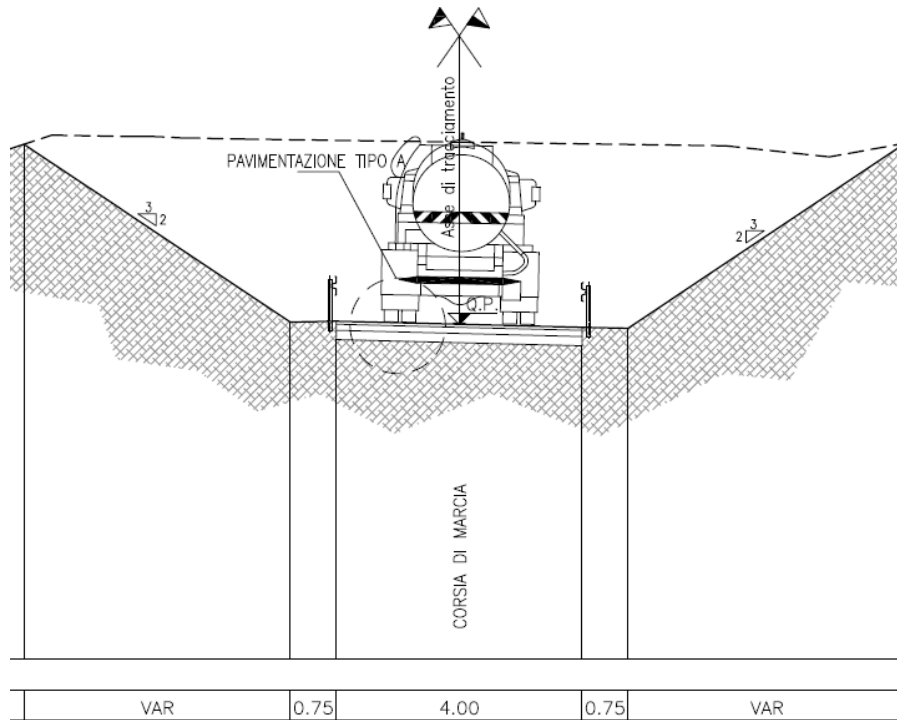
Sezione tipo strada di cantiere/security (trincea)
